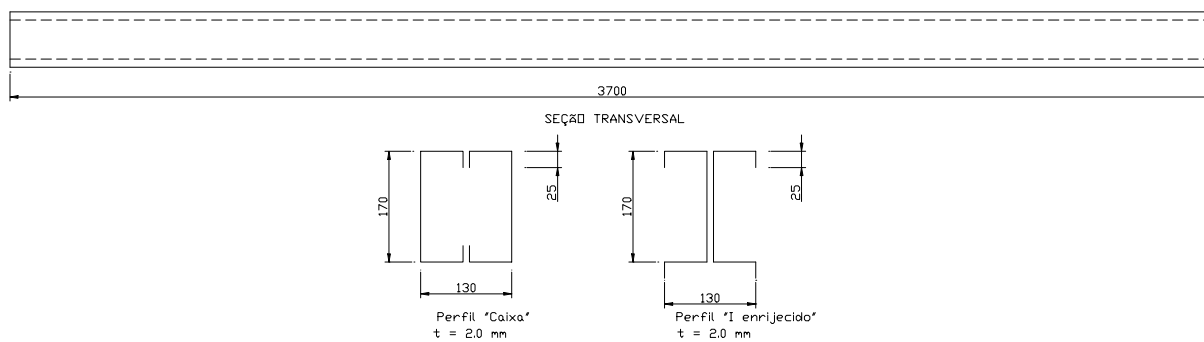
Modelos adotados para ensaio em vigas de aço .
